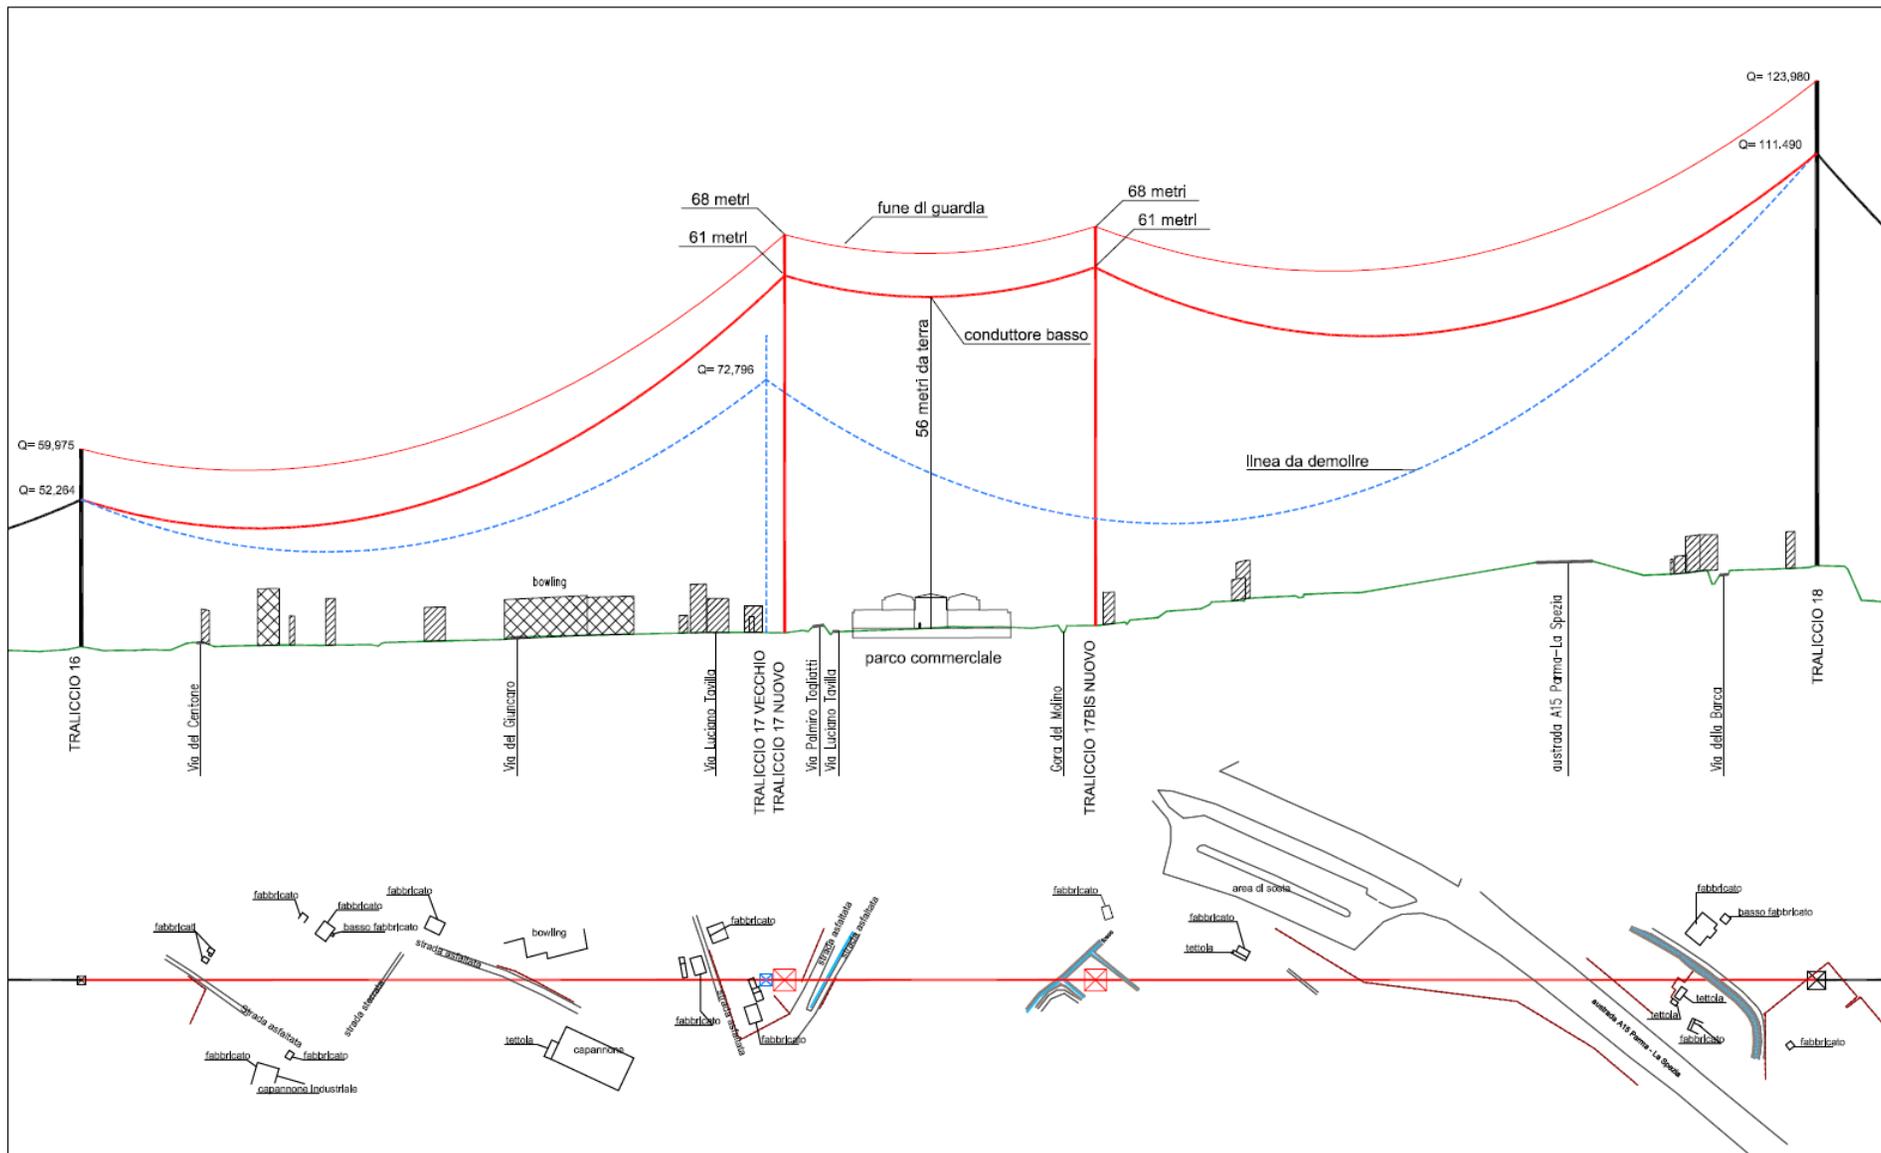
Sezione lungo le campate 16-17, 17-17bis, 17bis-18 (stato attuale e progetto).
